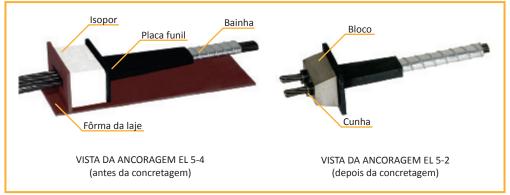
Ancoragem ativa Rudloff tipo "EL", antes e depois da concretagem (VISTA DO CONJUNTO)
